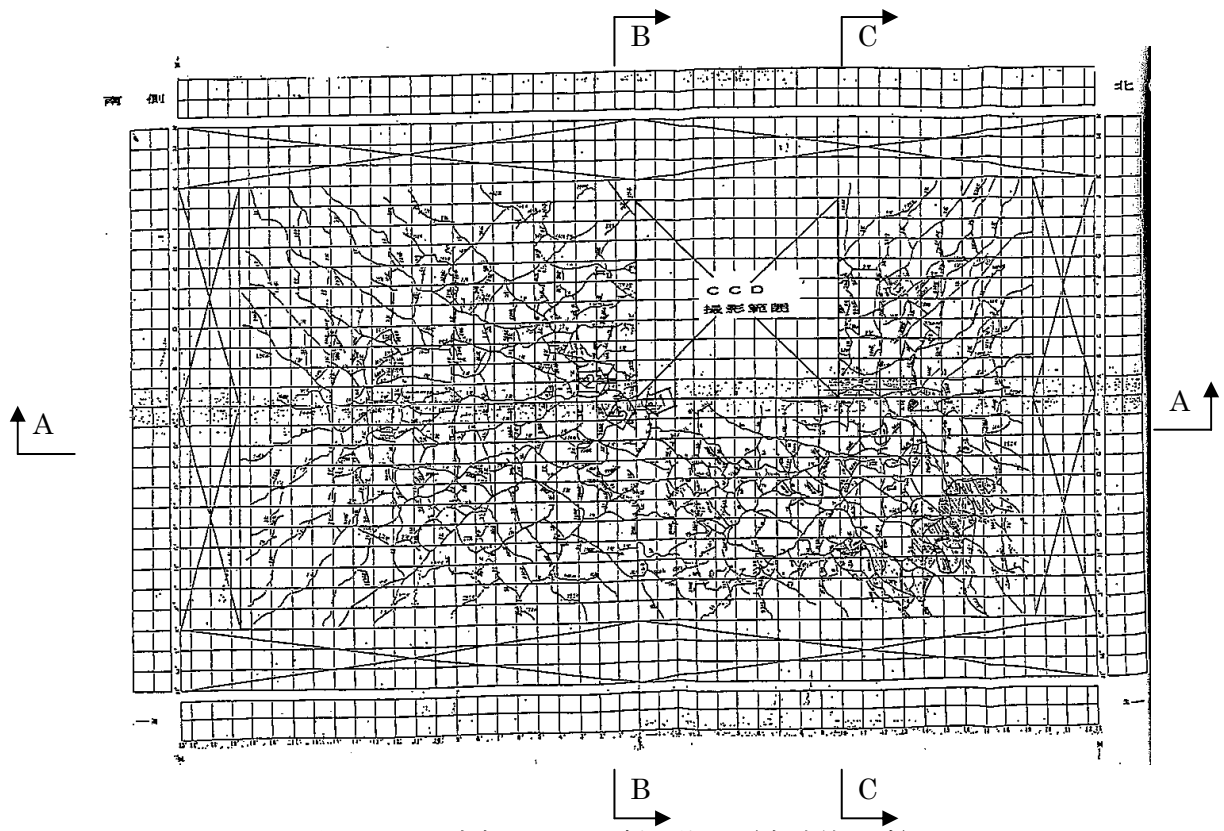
床版下面ひび割れ状況 (実験終了時)
